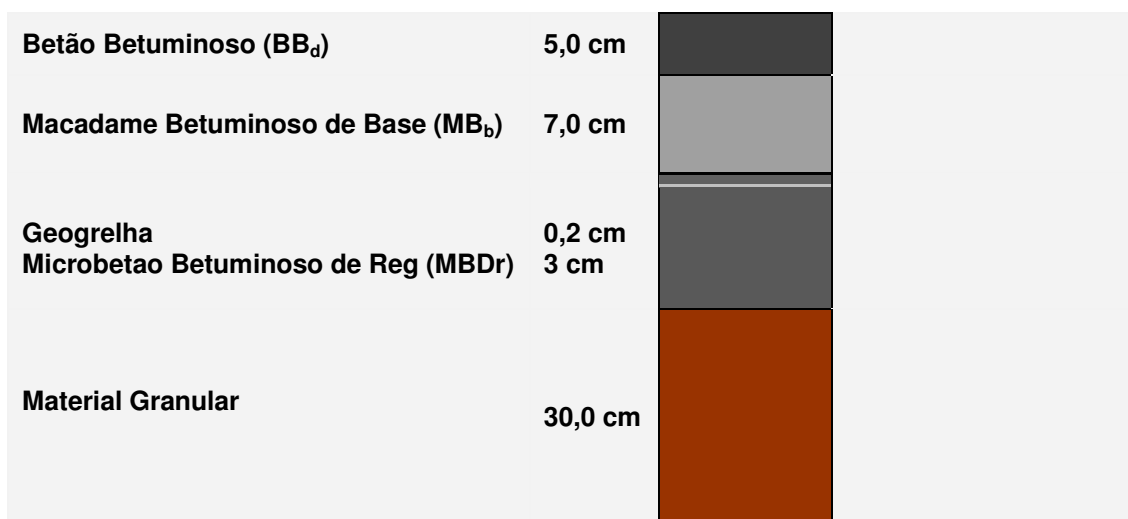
Estrutura Pavimento Final nos Locais com Ruína na Fundação
